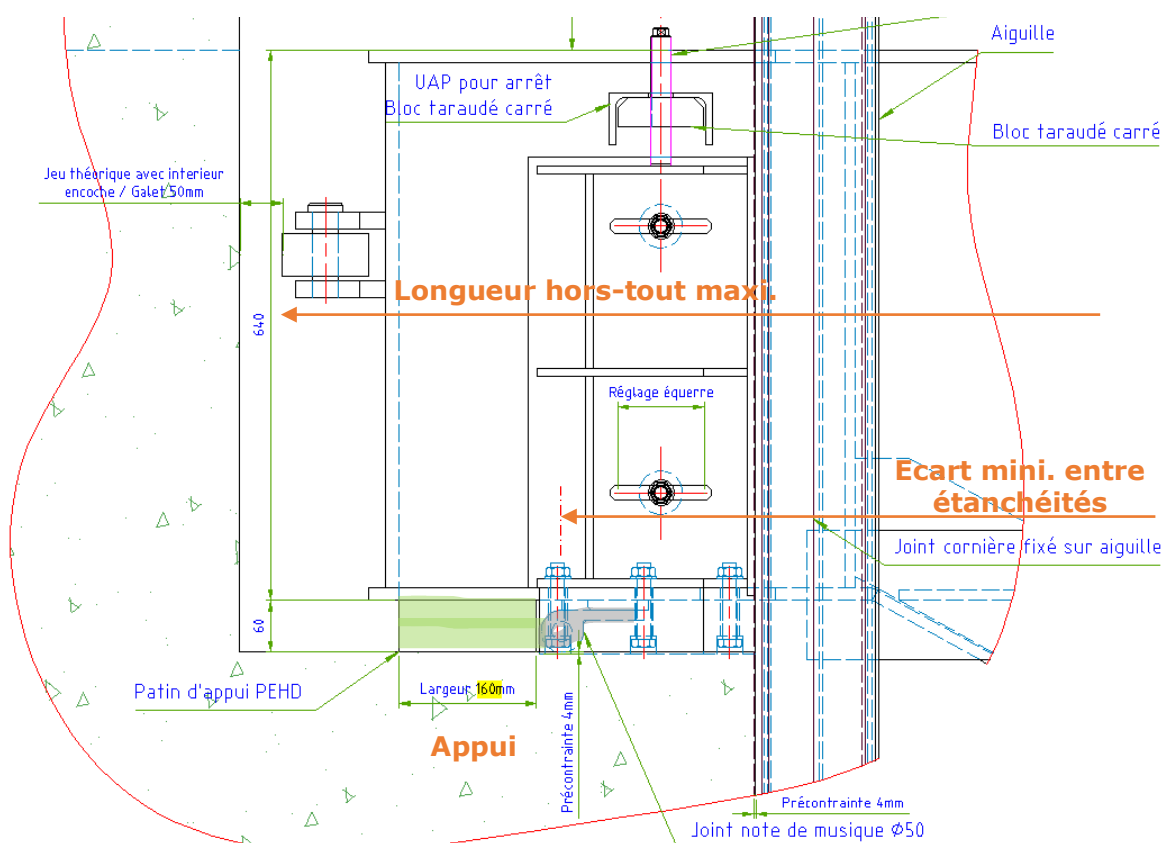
vue des extrémités de poutre amont (coupe rainure)
